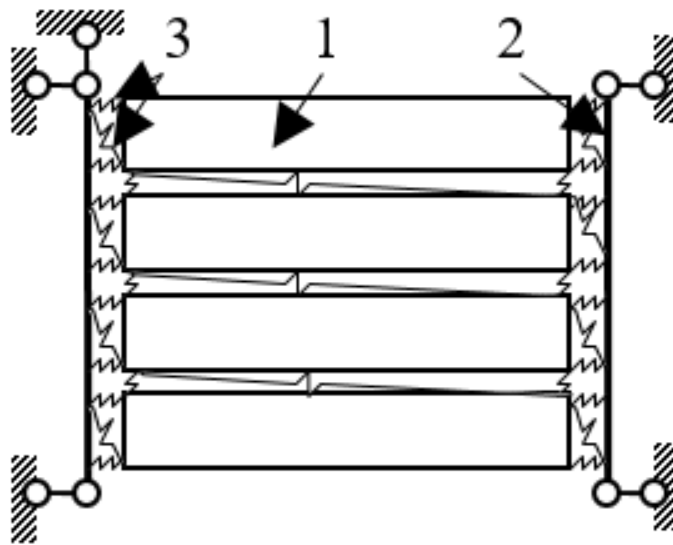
Расчетная модель фрагмента перекрытия:
